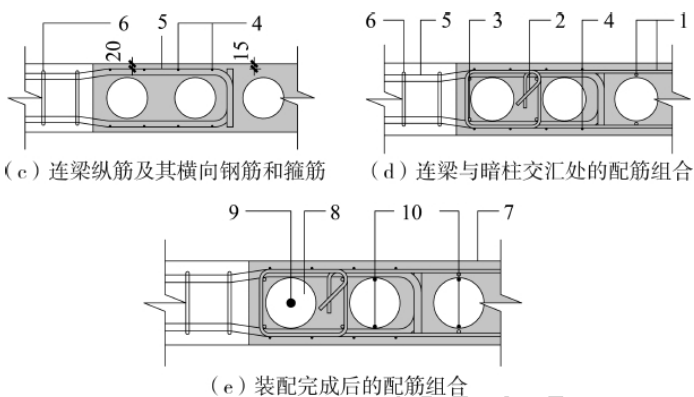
连梁与暗柱交汇处配筋及装配构造示意图
